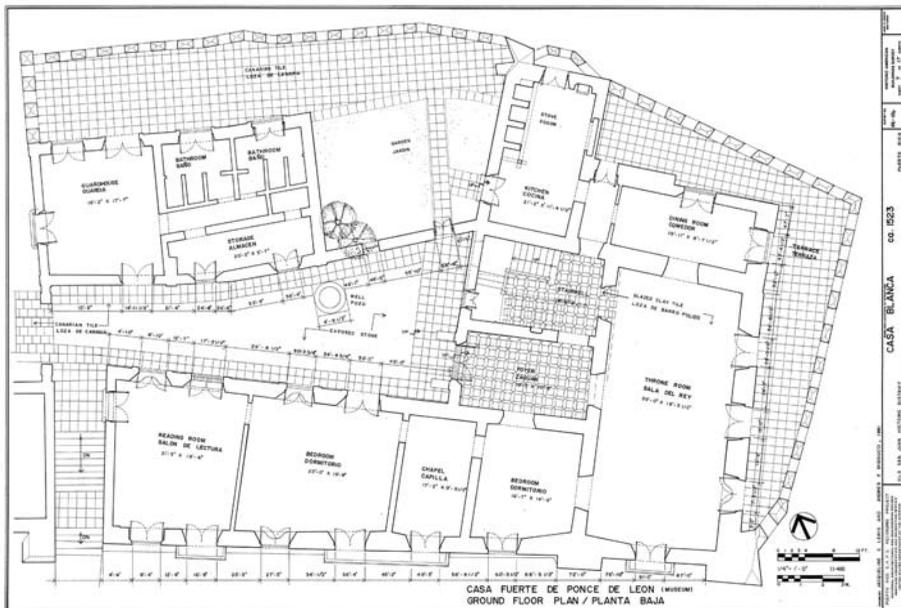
Detalle de la planta baja del edificio del museo en los planos de Casa Blanca de 1981. Copiado del Historic American Building Survey, United States Department of the Interior.
